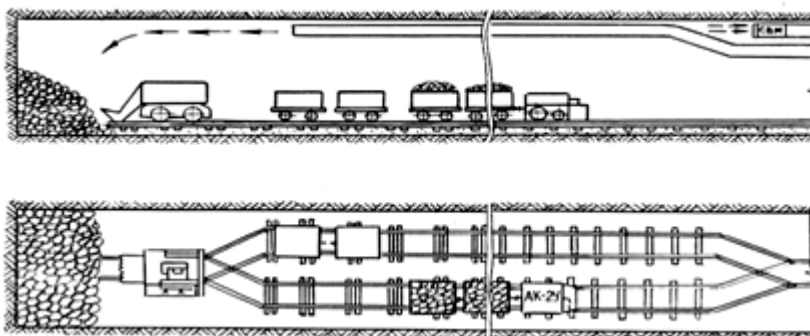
Проходка выработки с обменом вагонов на накладной плите
